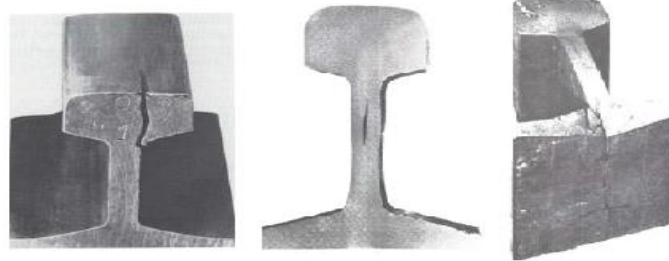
Fissuração longitudinal vertical (Couto, 2008)
